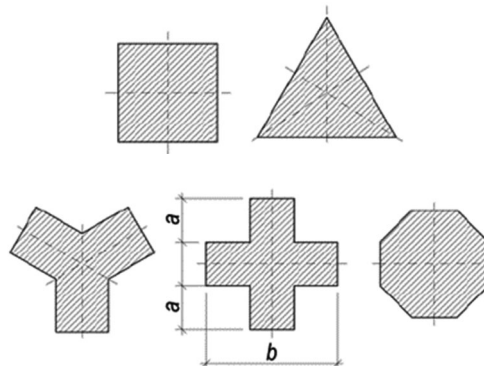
Фундаменты с измененной плоской подошвой, испытанные А. В. Глушковым
